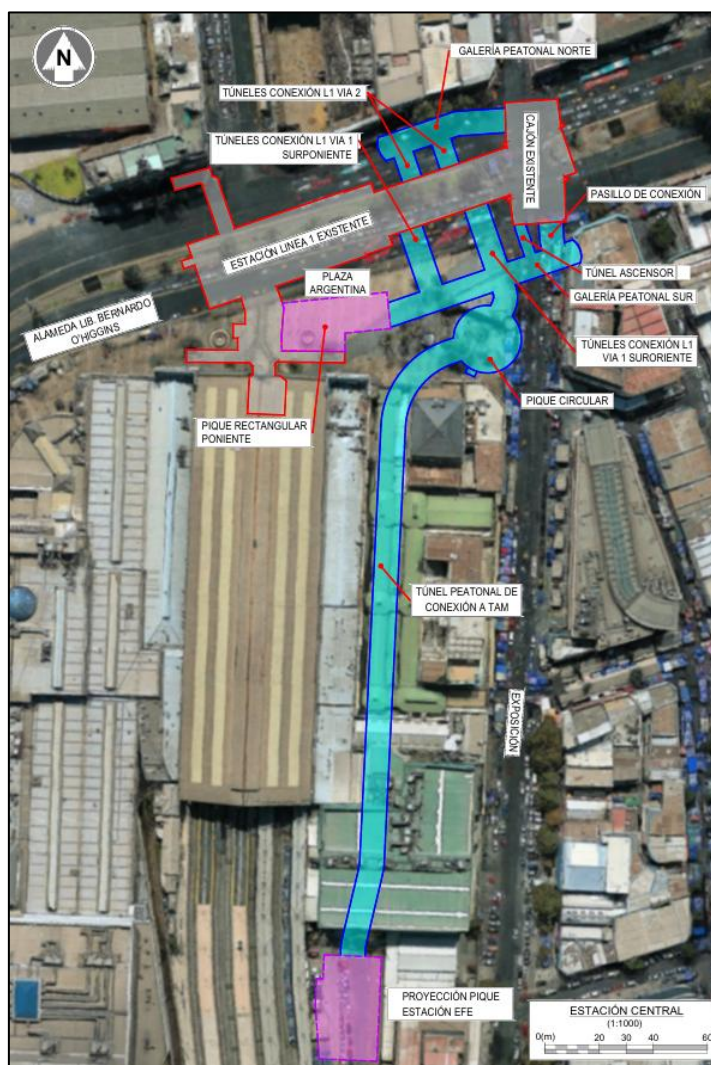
Vista en planta con indicación de las obras evaluadas dentro del alcance de este documento
